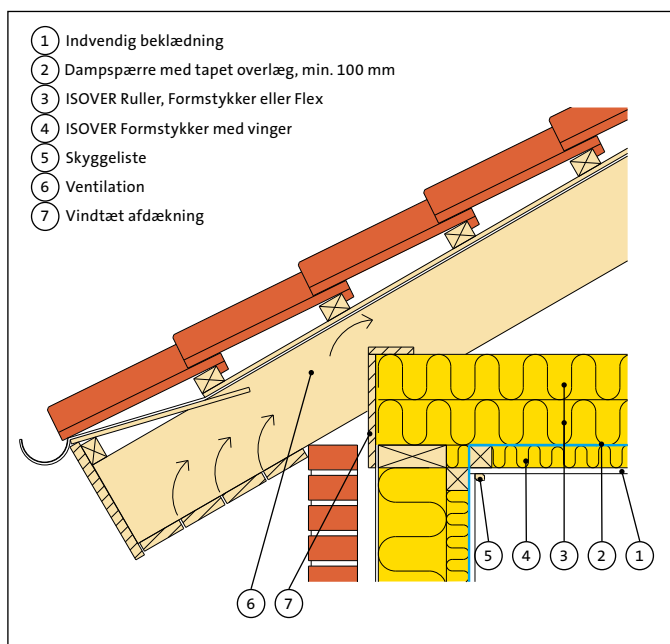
Loftkonstruktion isoleret med flere lag ISOVER, hvoraf 45 mm er placeret under dampspærren.
